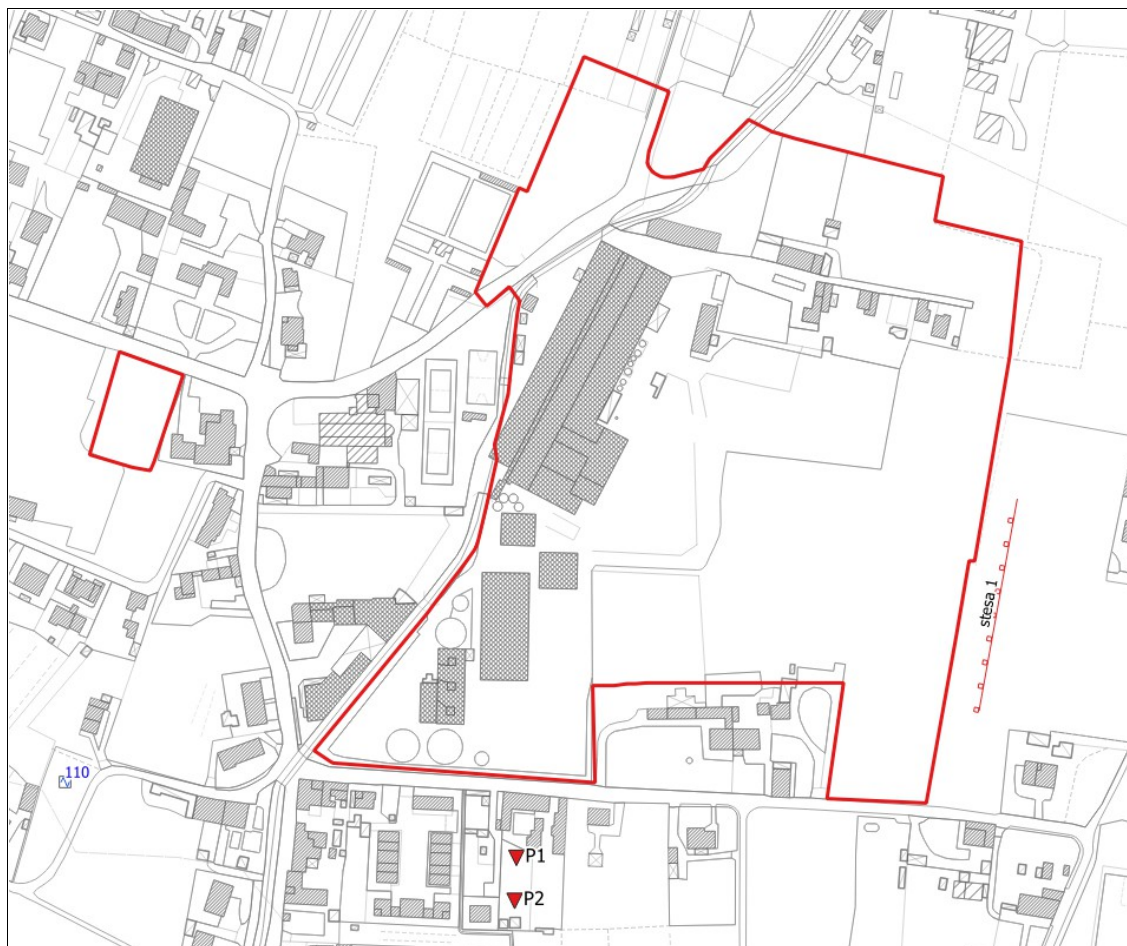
Planimetria con ubicazione delle indagini – fuori scala
